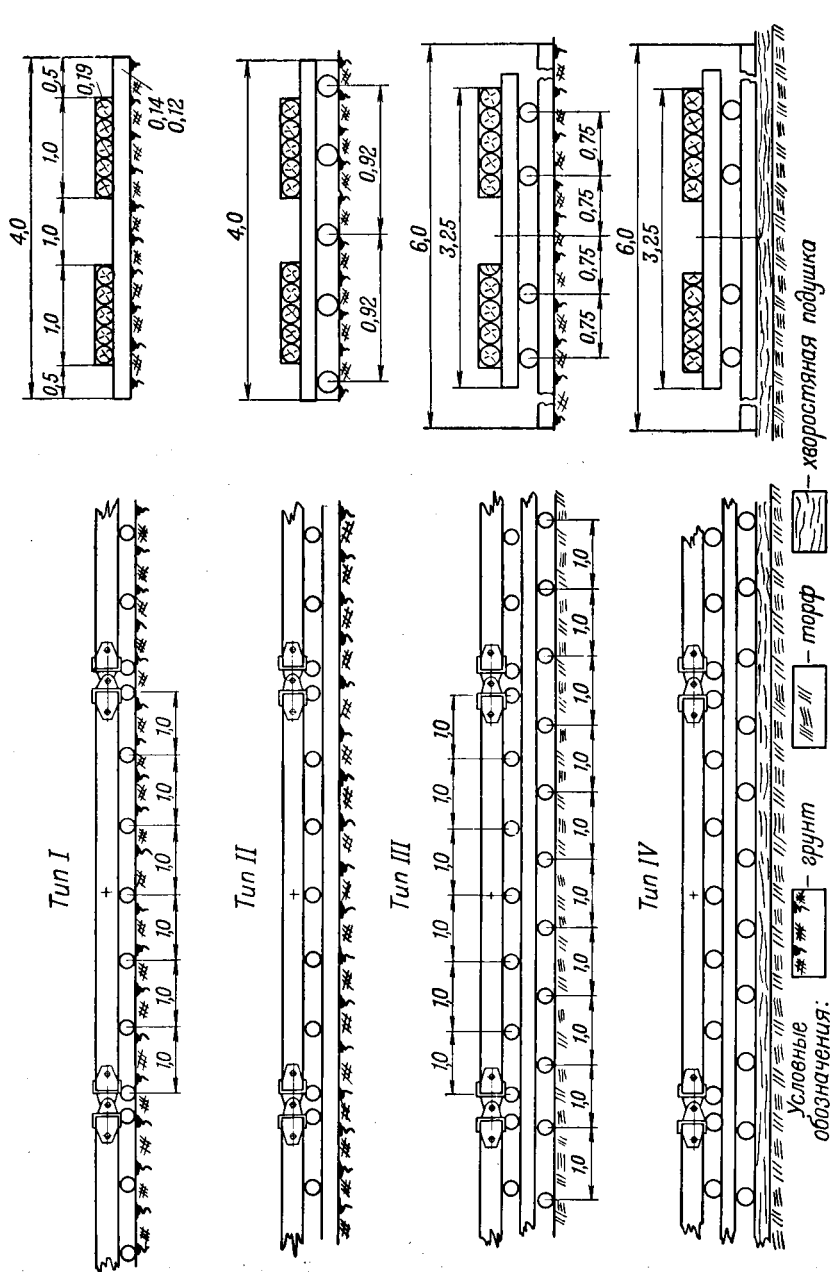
Типы усов с покрытием из деревянных щитов с металлическим креплением конструкции ЦНИИМЭ:
